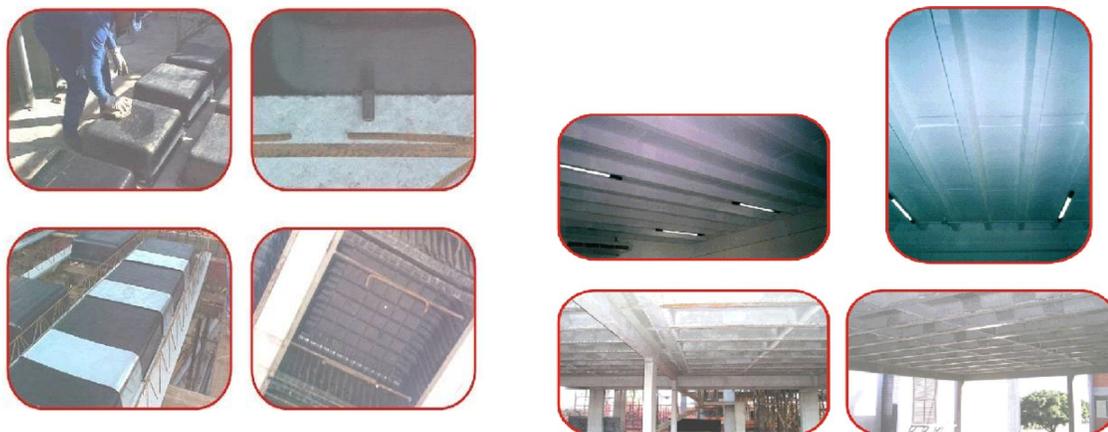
Lajes Lisas Nervuradas Bidirecionais com vigotas pré-fabricadas treliçadas e vigas de borda na espessura da laje.
